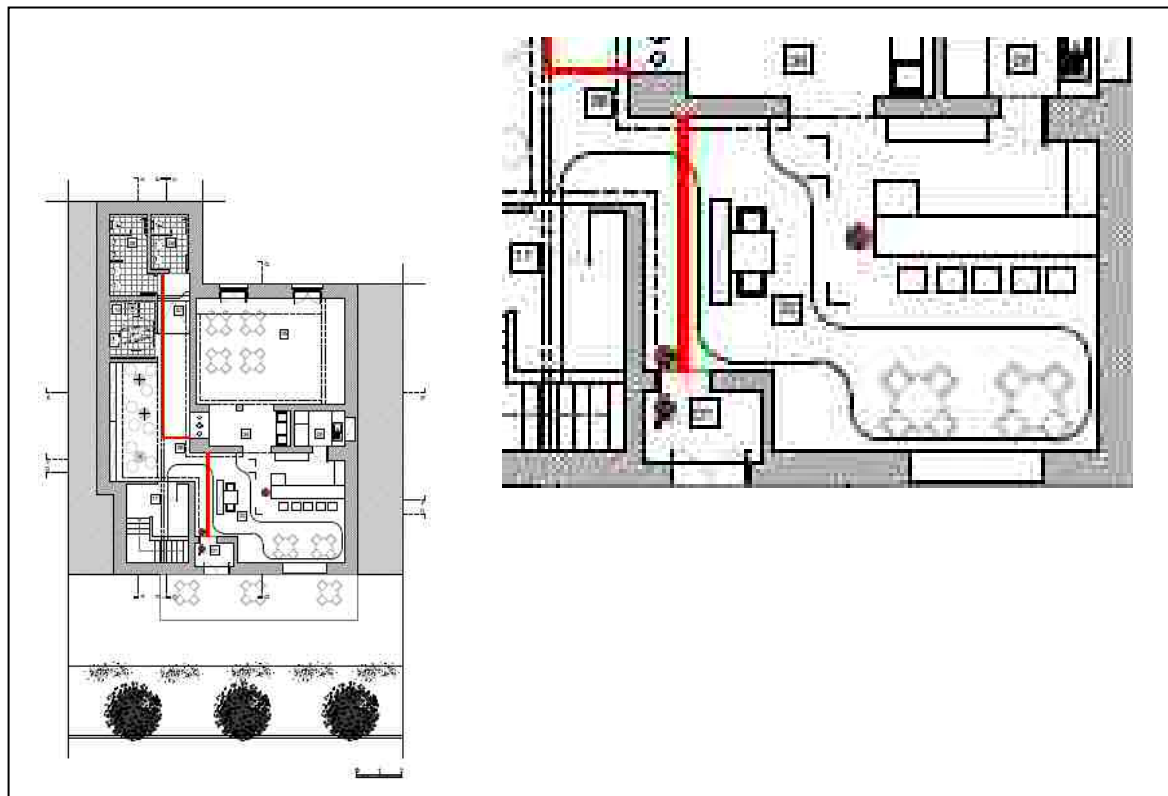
Planta Piso 0, Sala Fundação - Circuito e barra cronológica, proposta ECB.
